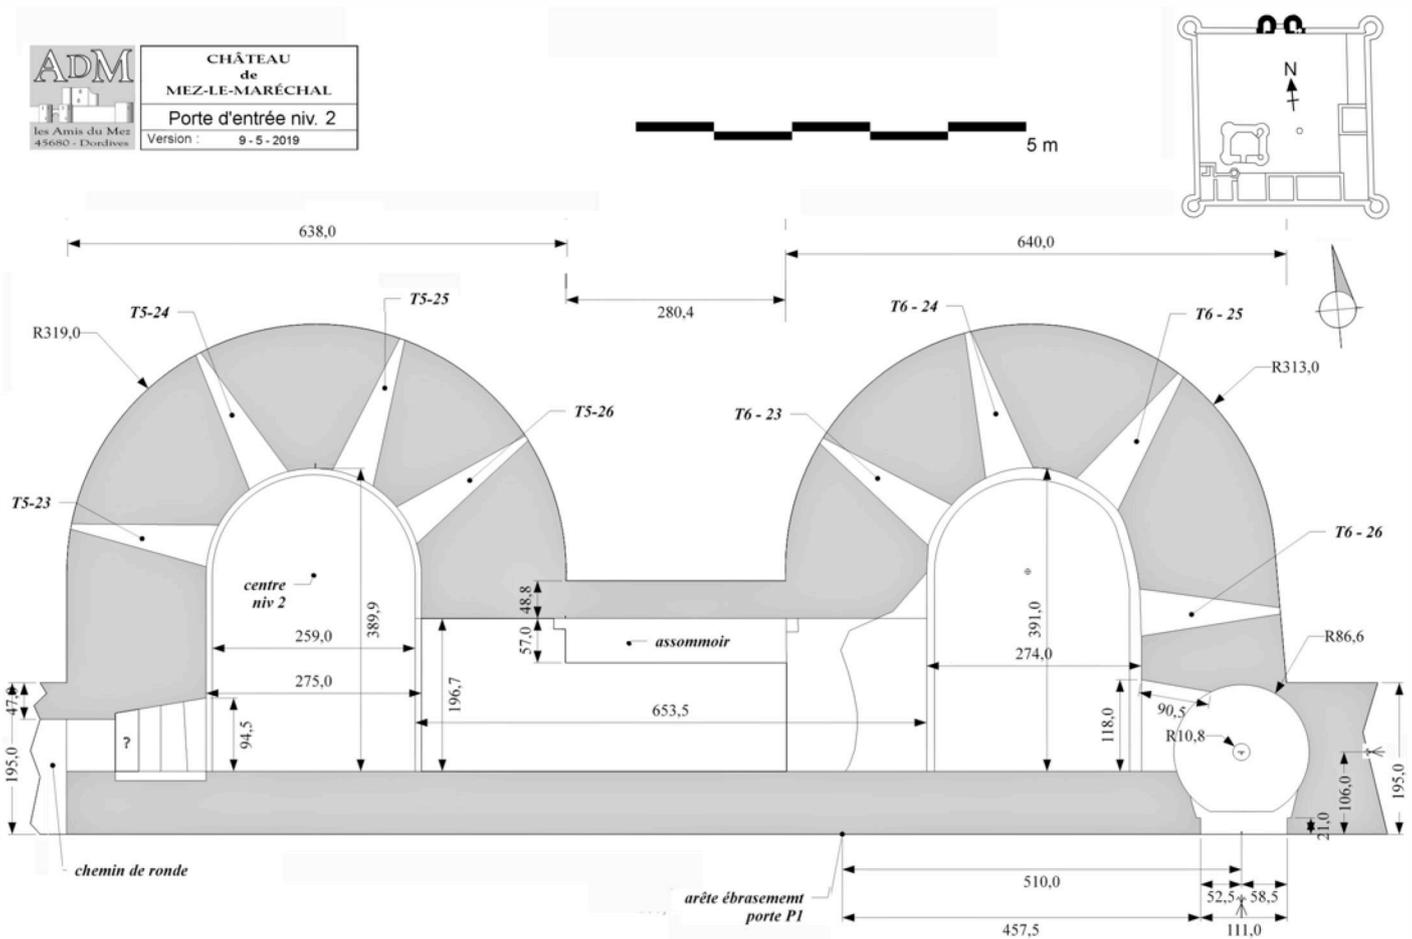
Plan de la porte à deux tours - Niveau 2 (DAO : Michel Piechaczyk / ADM).
